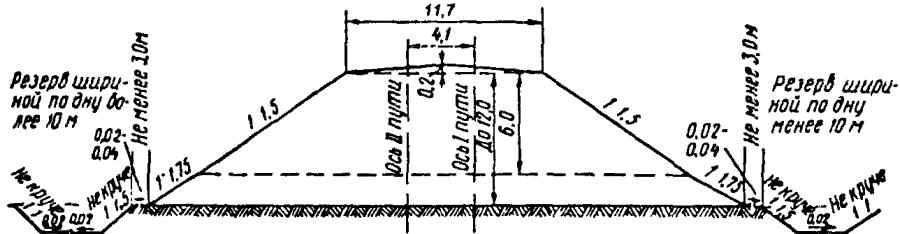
Насыпь высотой до 12 м с шириной основной площадки 11,7 м при по-
